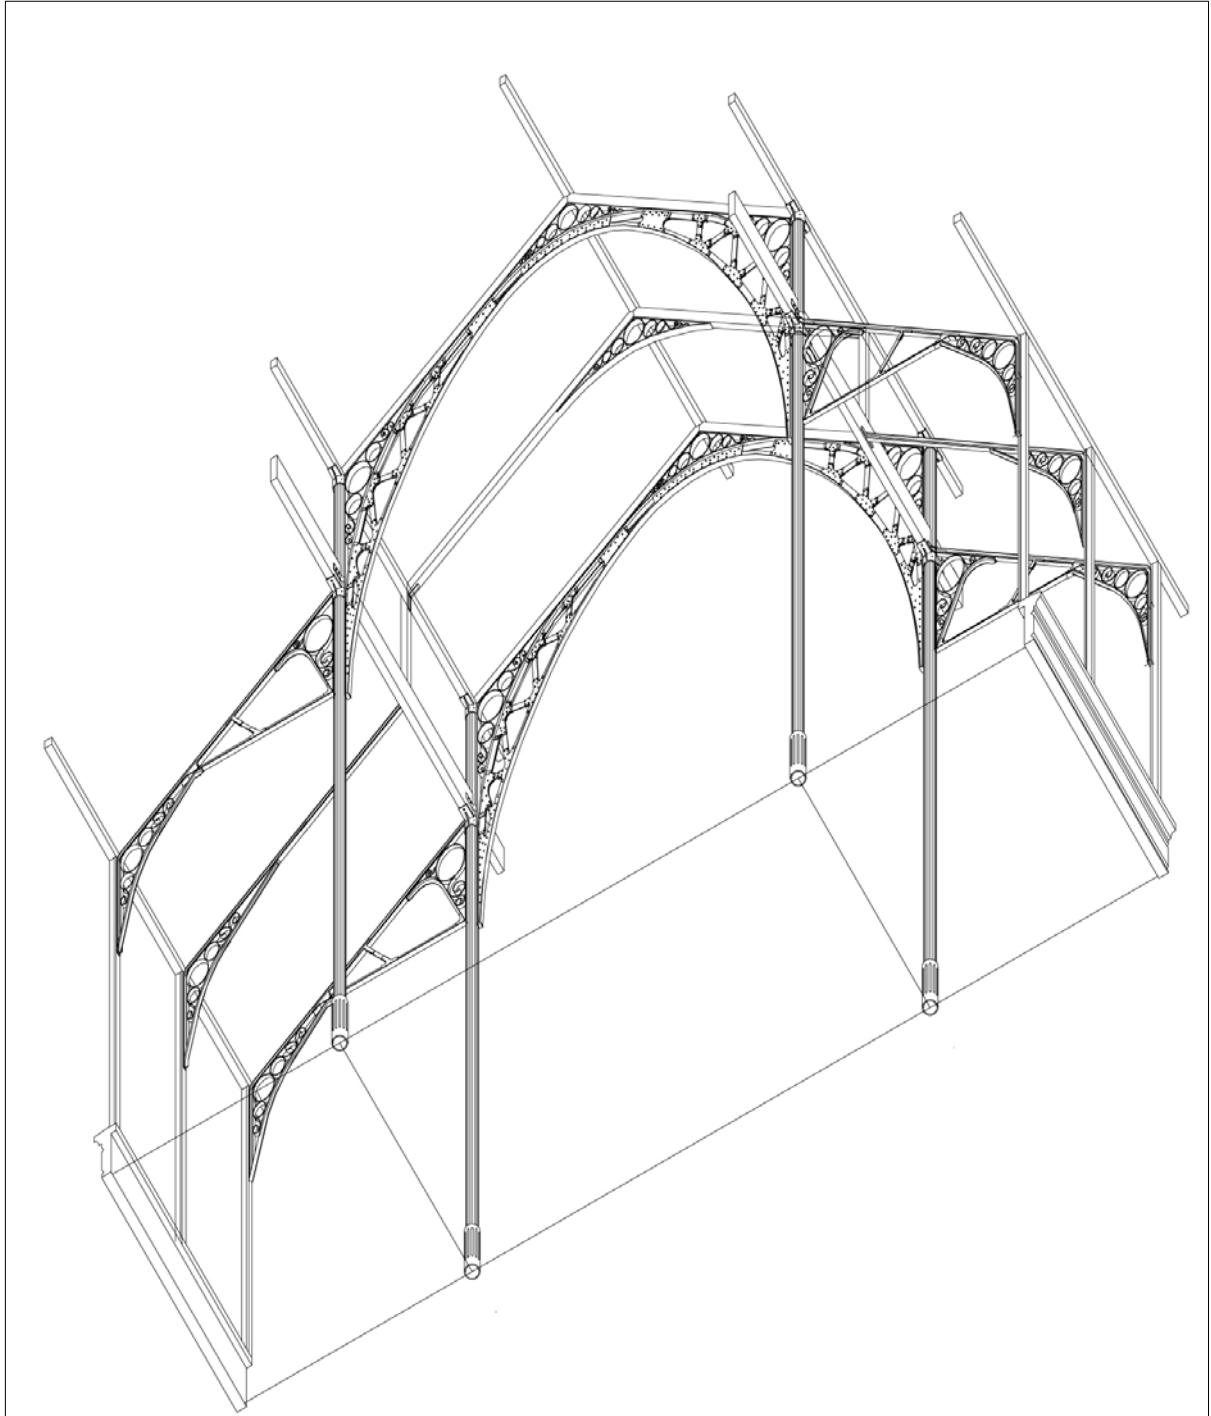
창경궁 대온실의 구조부 부분(Up-view drawing)/출처 : 최아신 석사논문
